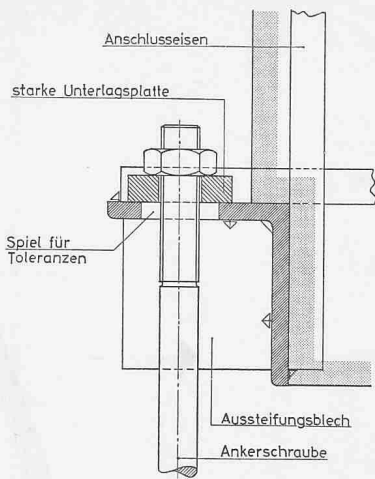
Detail A zum biegesteifen Anschluss einer Erdgeschoss-Stütze an die Unterkonstruktion (siehe Bild 22). Masstab 1:6
